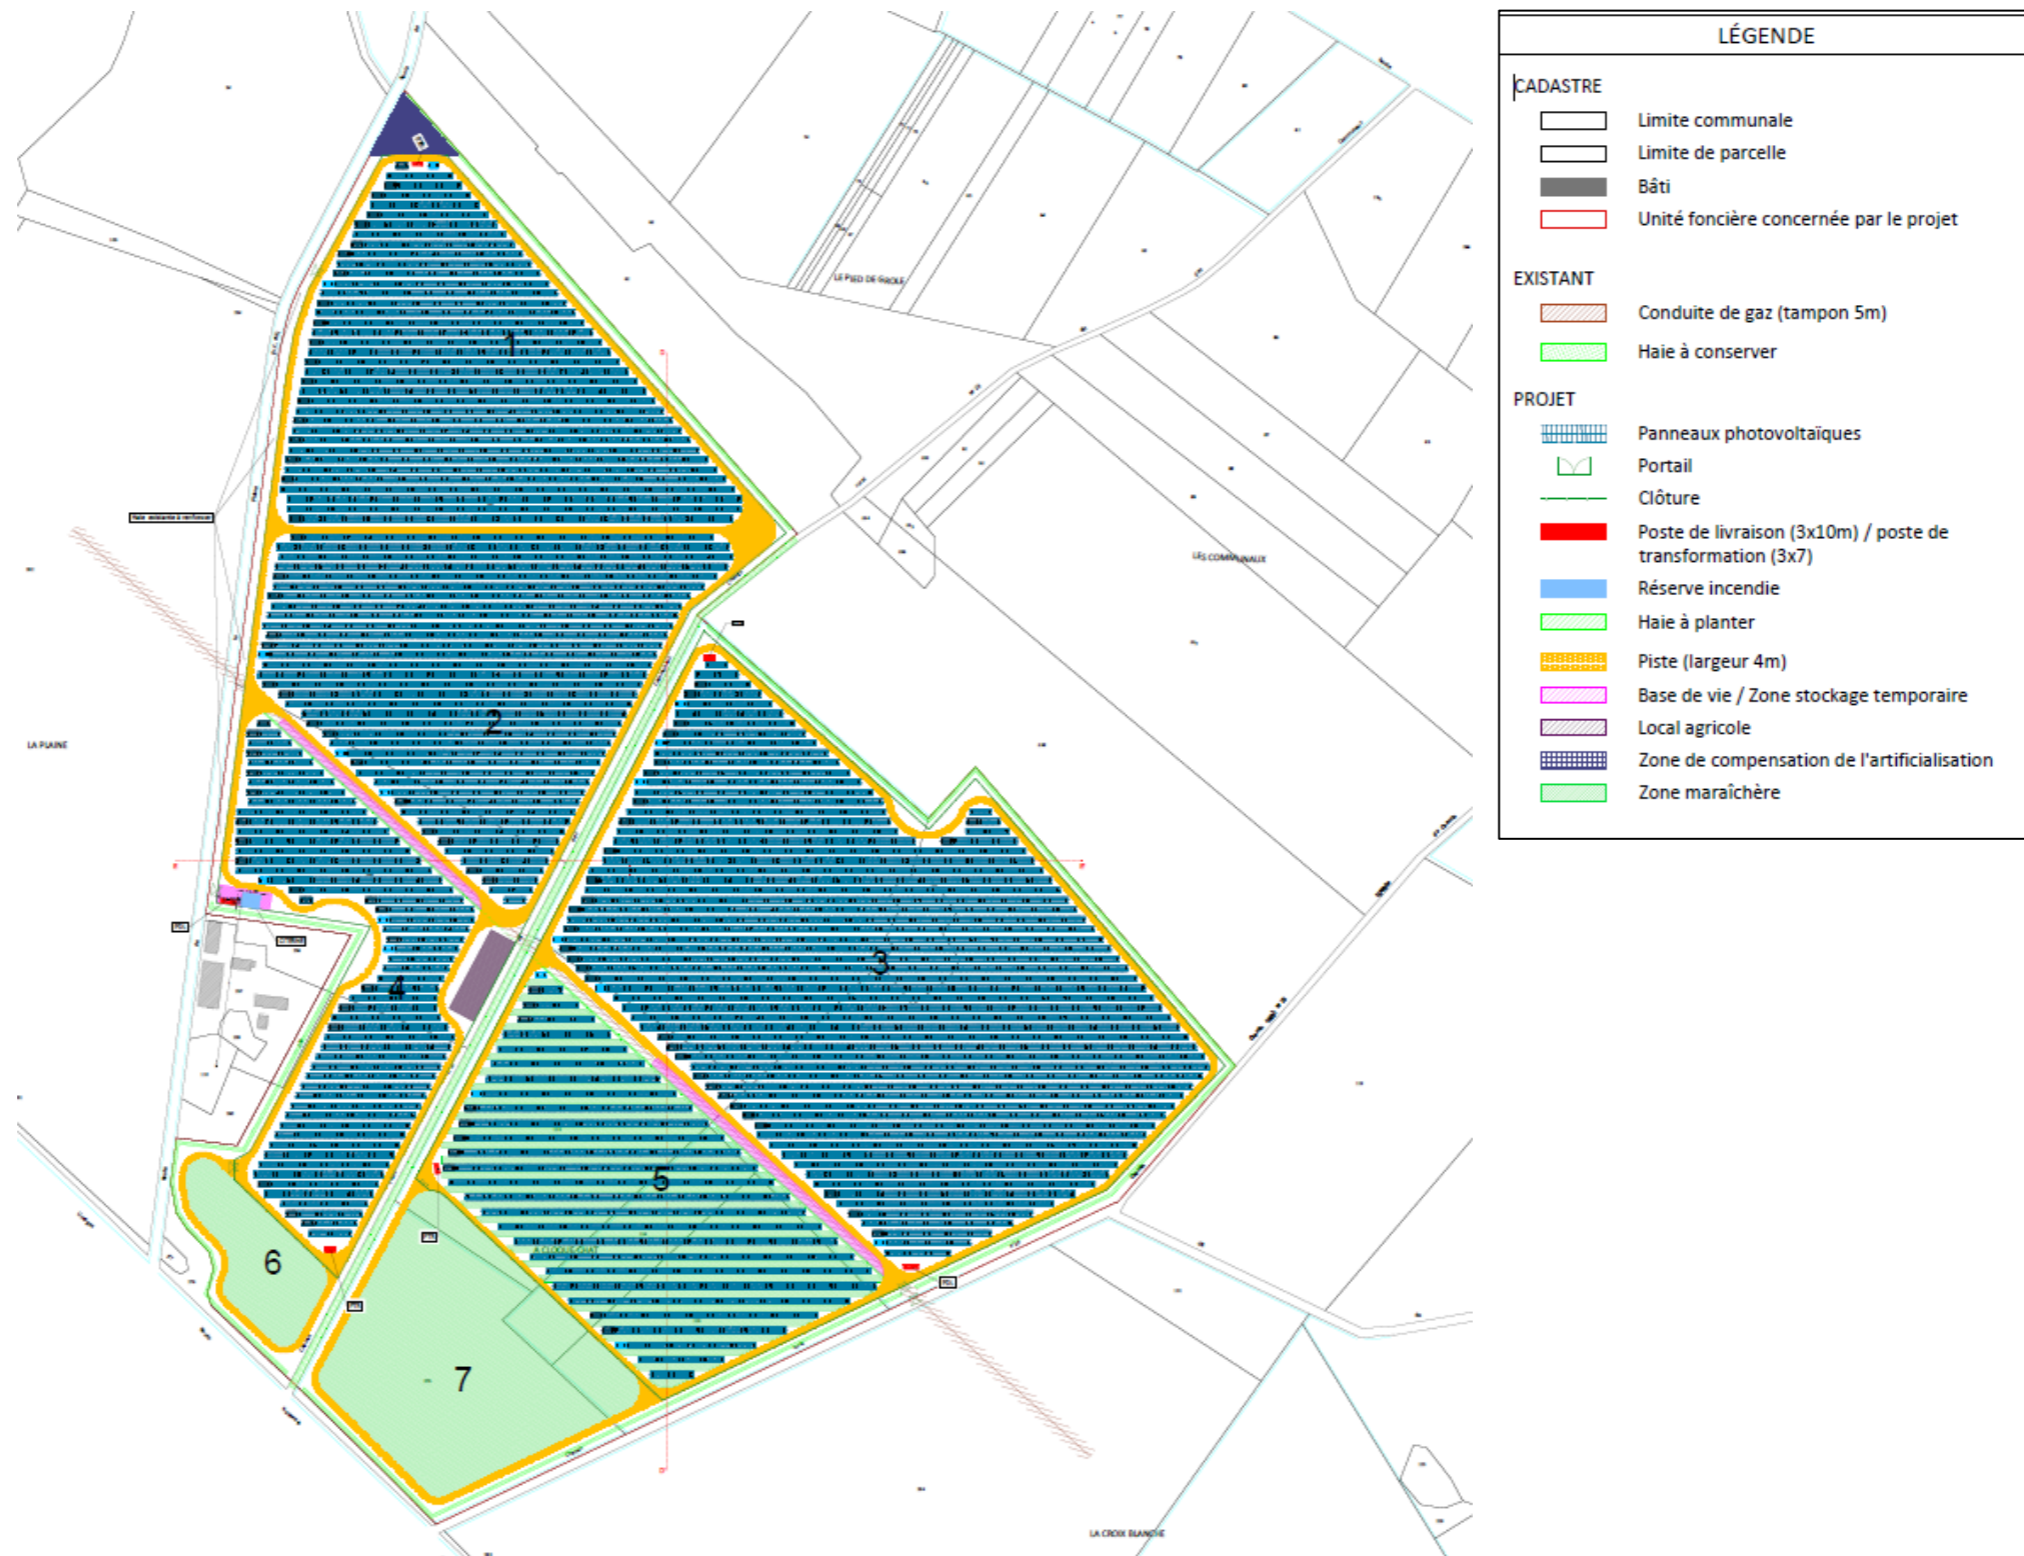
Plan de la centrale agri-solaire – source : VALECO
